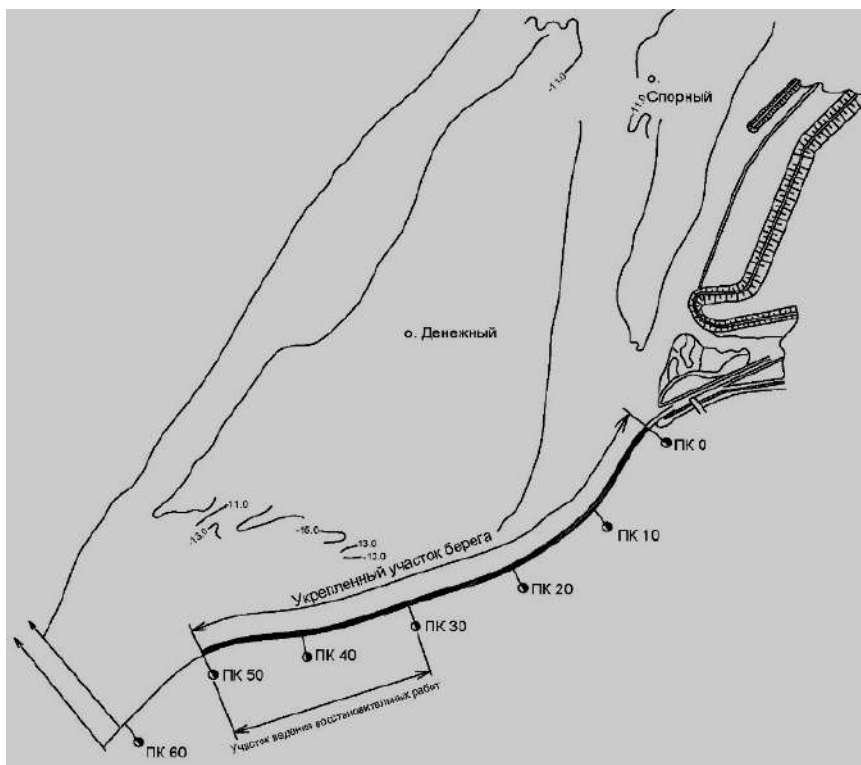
Схематичный план укрепления левого берега р. Волга
